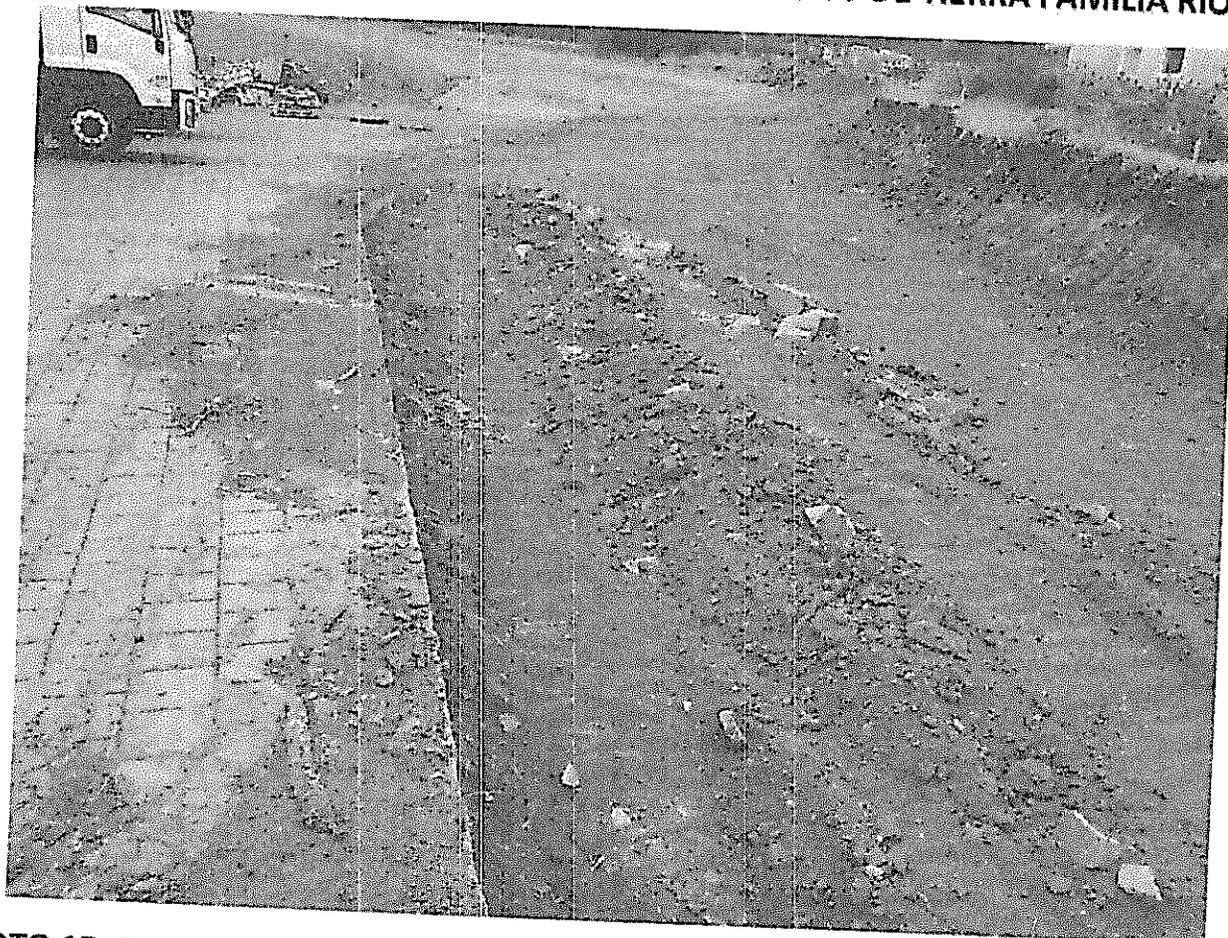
APERTURA DE CALLE SUR 12 METROS SEPARA IMPRENTA Y FAMILIA RÍOS
